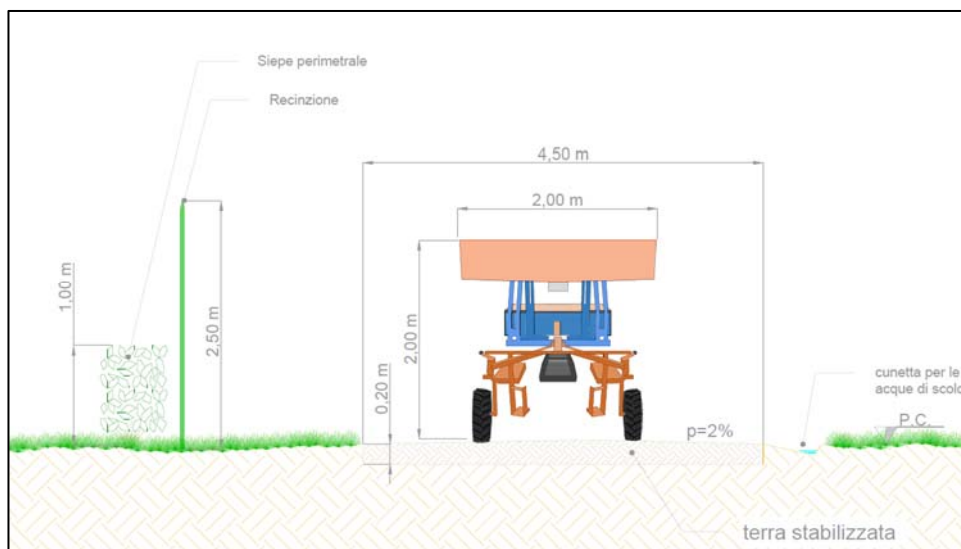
Dettaglio costruttivo delle strade per la viabilità interna al sito di installazione dell'impianto fotovoltaico
